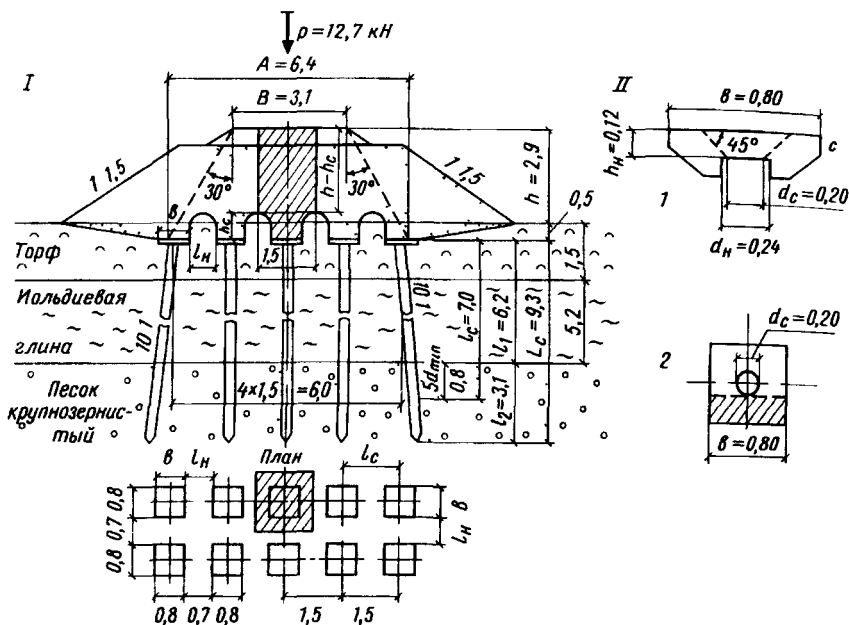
26 Расчетные схемы свай и наголовника I — к расчету свай II — к расчету наголовника 1 — подбор сечения наголовника 2 — подбор арматуры наголовника
